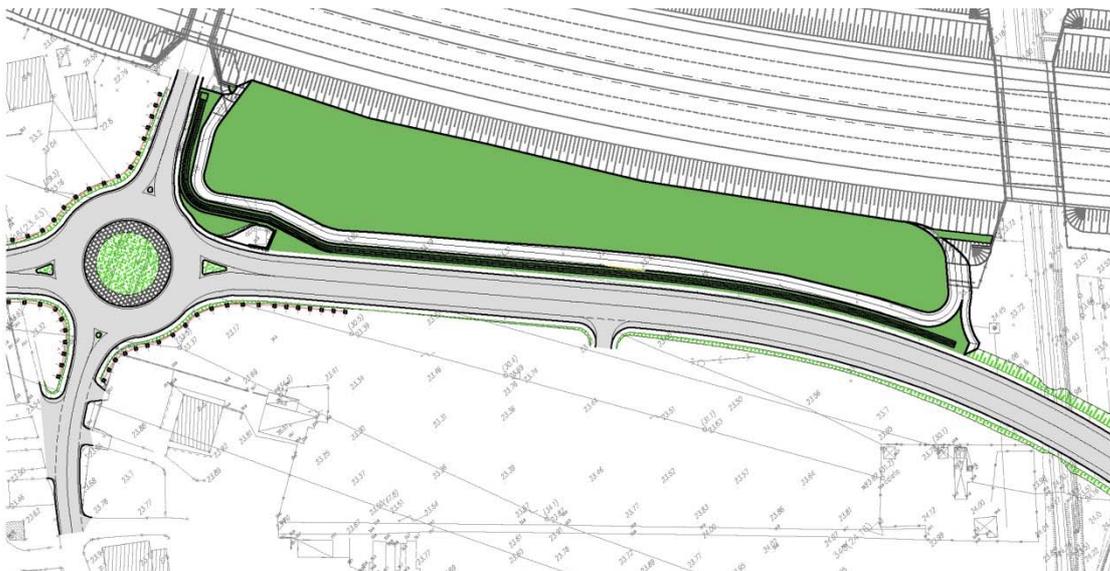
Stralcio planimetrico rimodellamento morfologico 1
